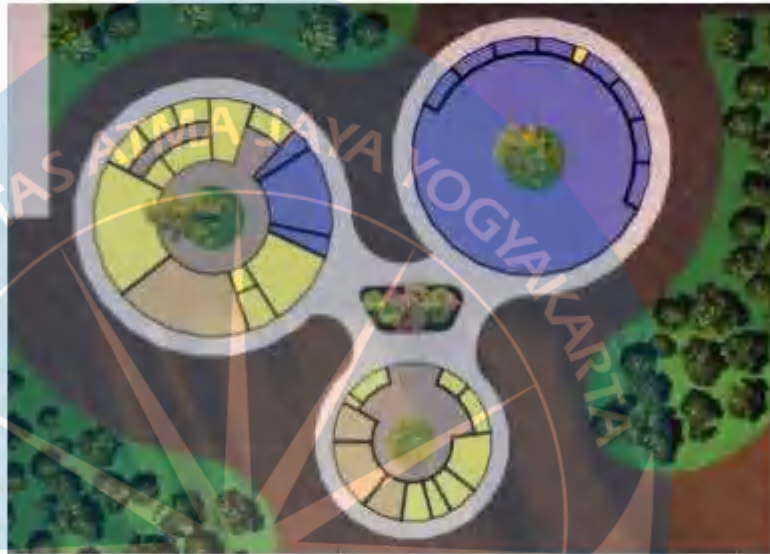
12 Ruang Hijau di Luar Bangunan
